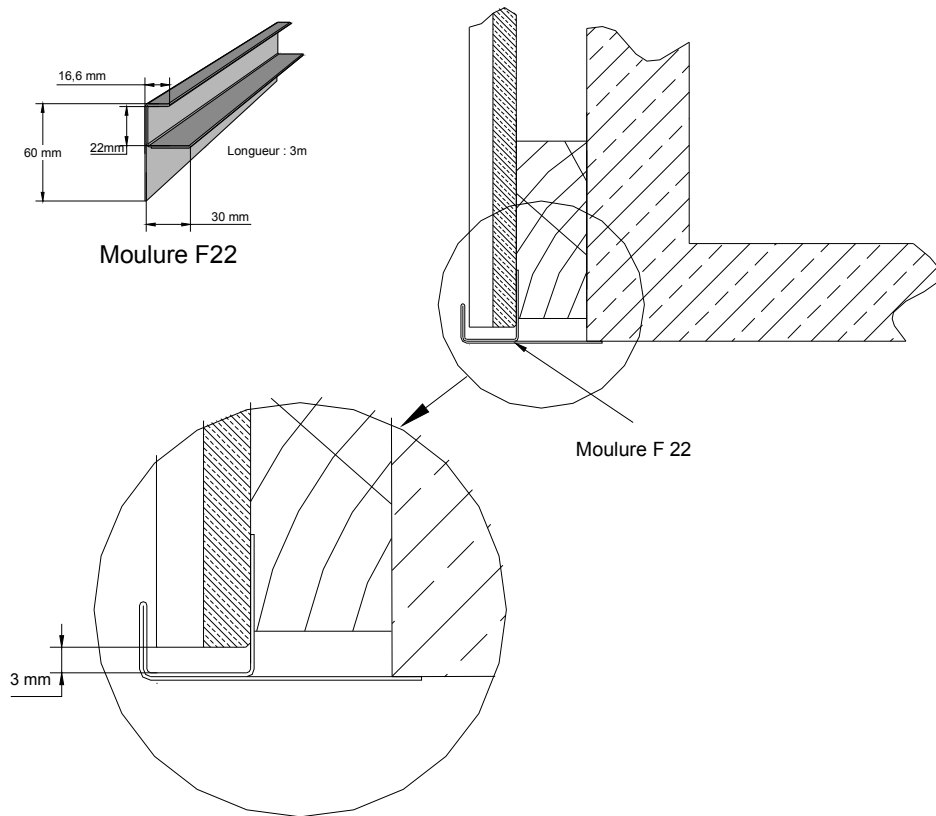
Arrêt latéral - Moulure F22 – Coupe horizontale
